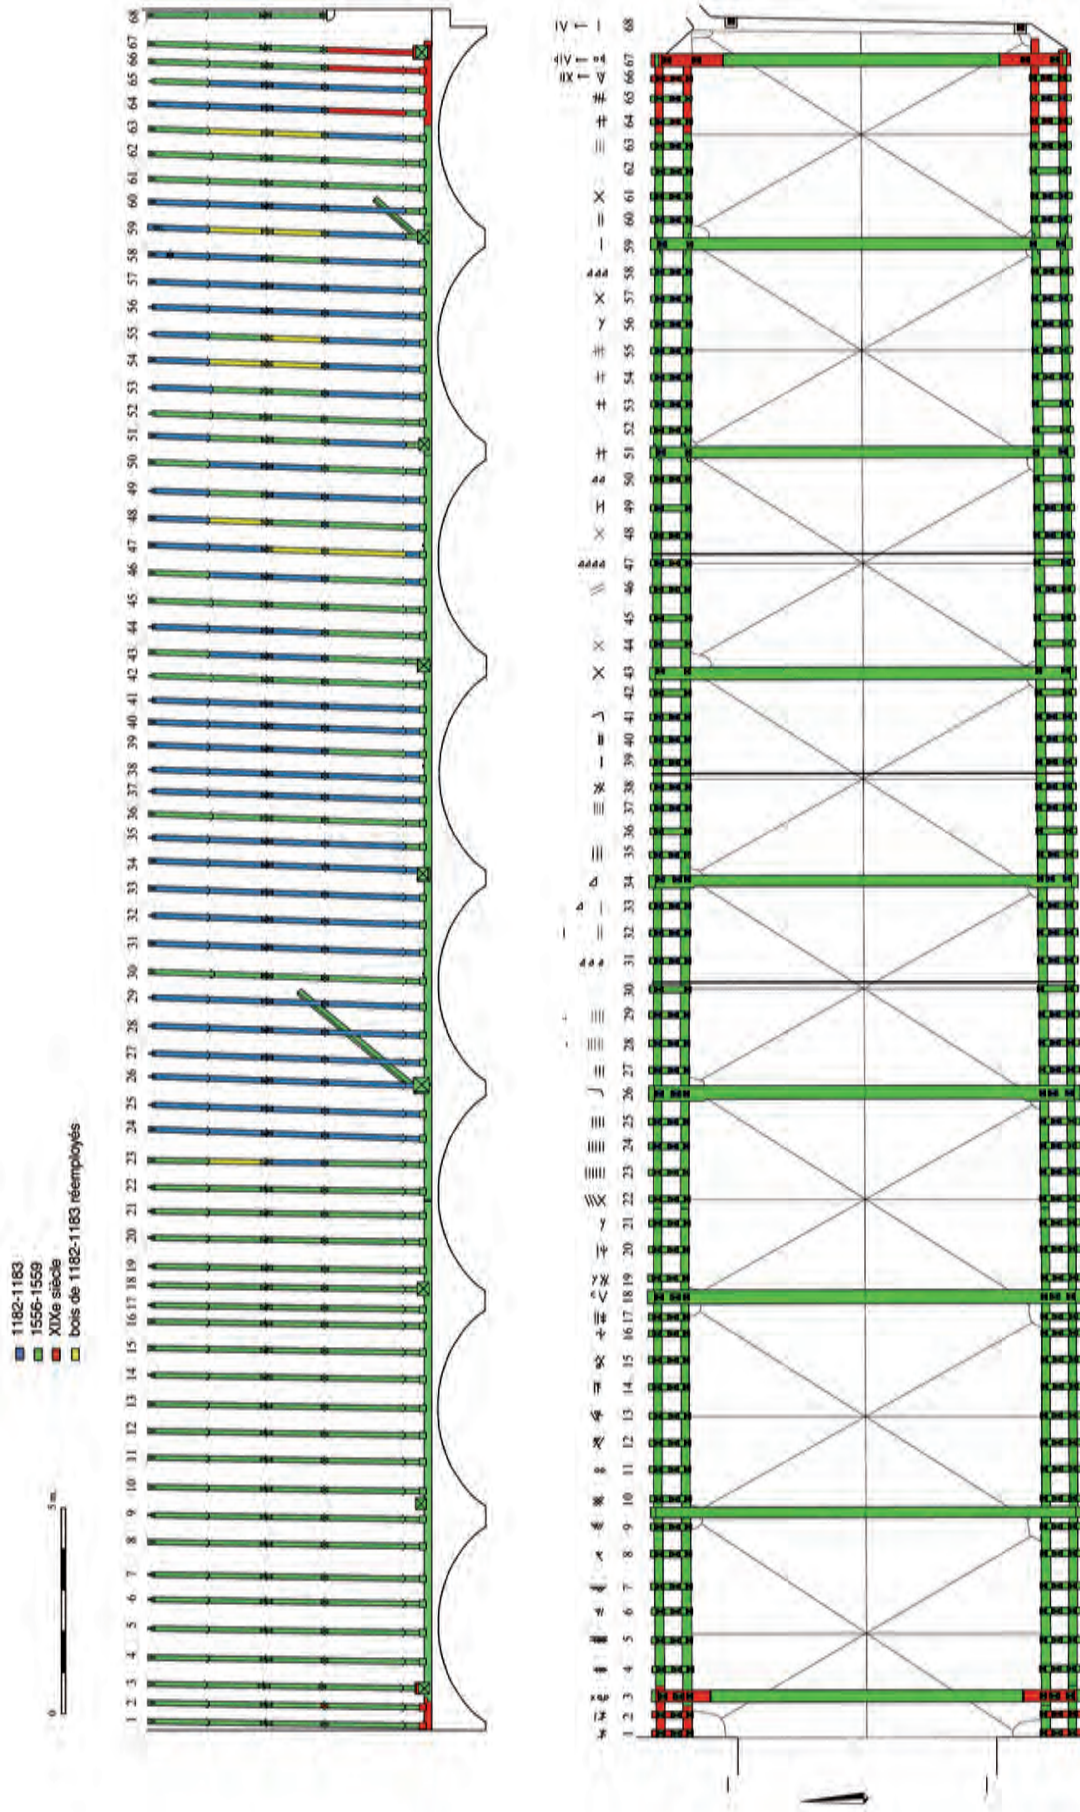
Charpente de la nef : coupe longitudinale ouest-est et plan au niveau des entrails.
